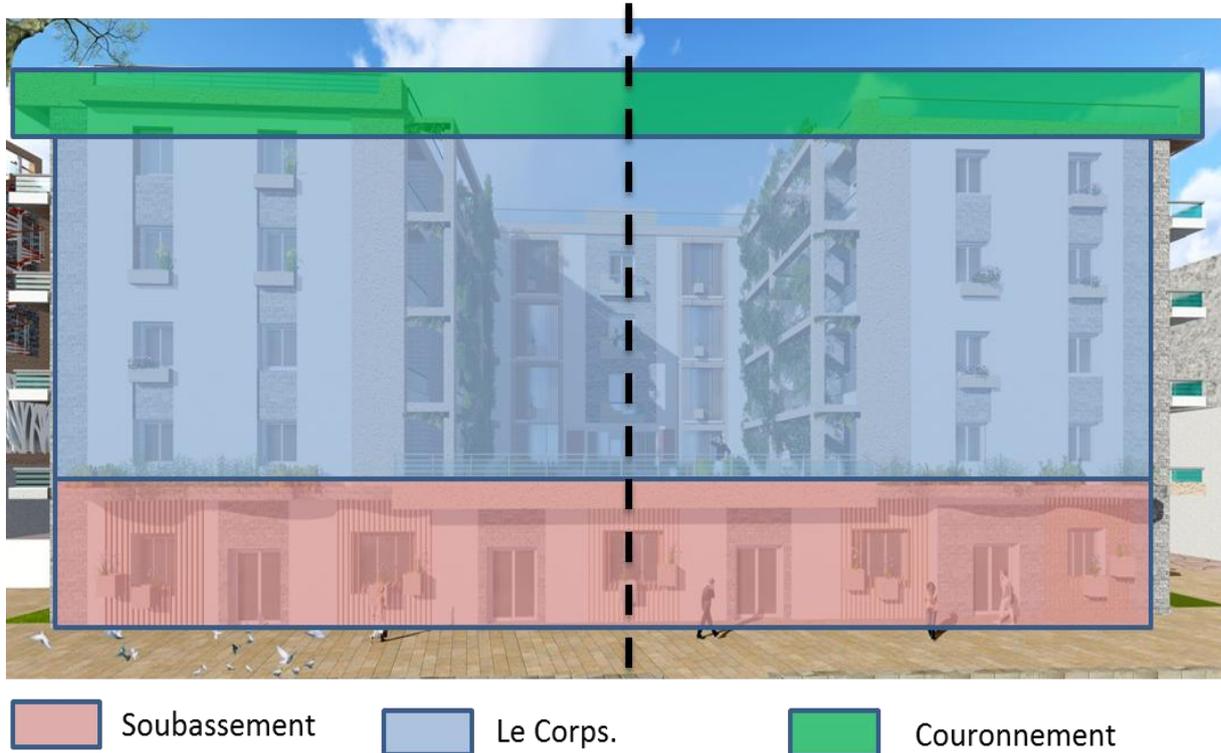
Présente traitement des façades de l'internat (Façade sud).
